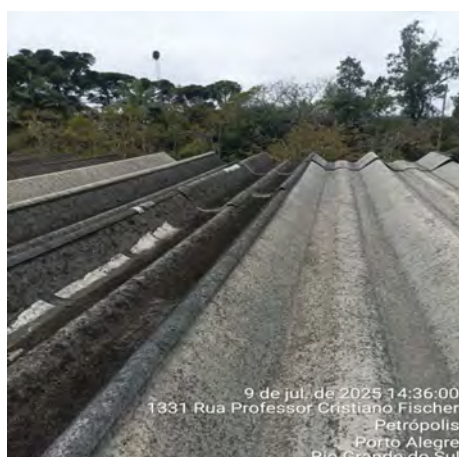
Telha Kalhetão quebradas e emendadas com manta
